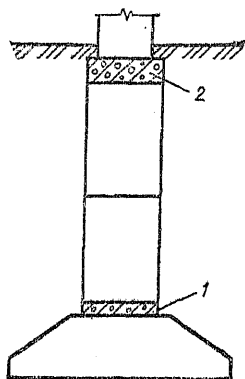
Размещение железобетонных поясов в подвальной части зданий, устраиваемых на сильносжимаемых грунтах 1 — по верху фундамента; 2 — на уровне цокольной части
